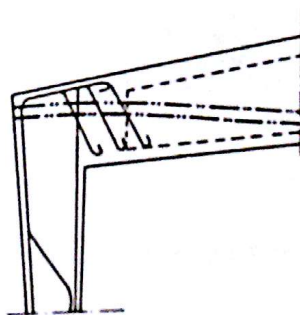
PILAR COM ARMADURA PASSIVA
